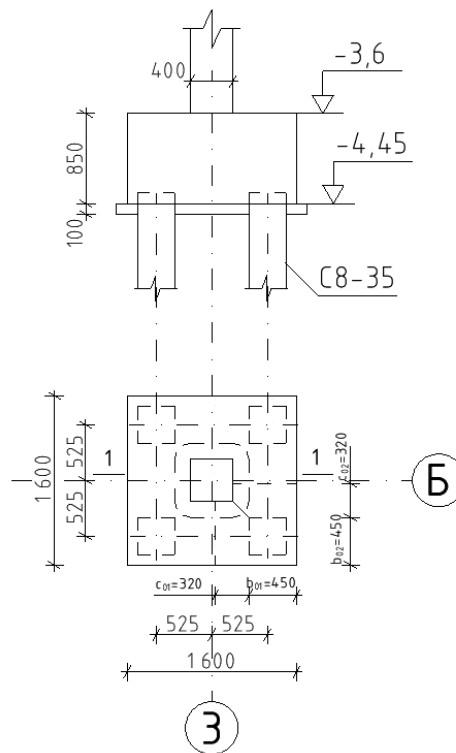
Схема ростверка для фундаменту з 4 паль
